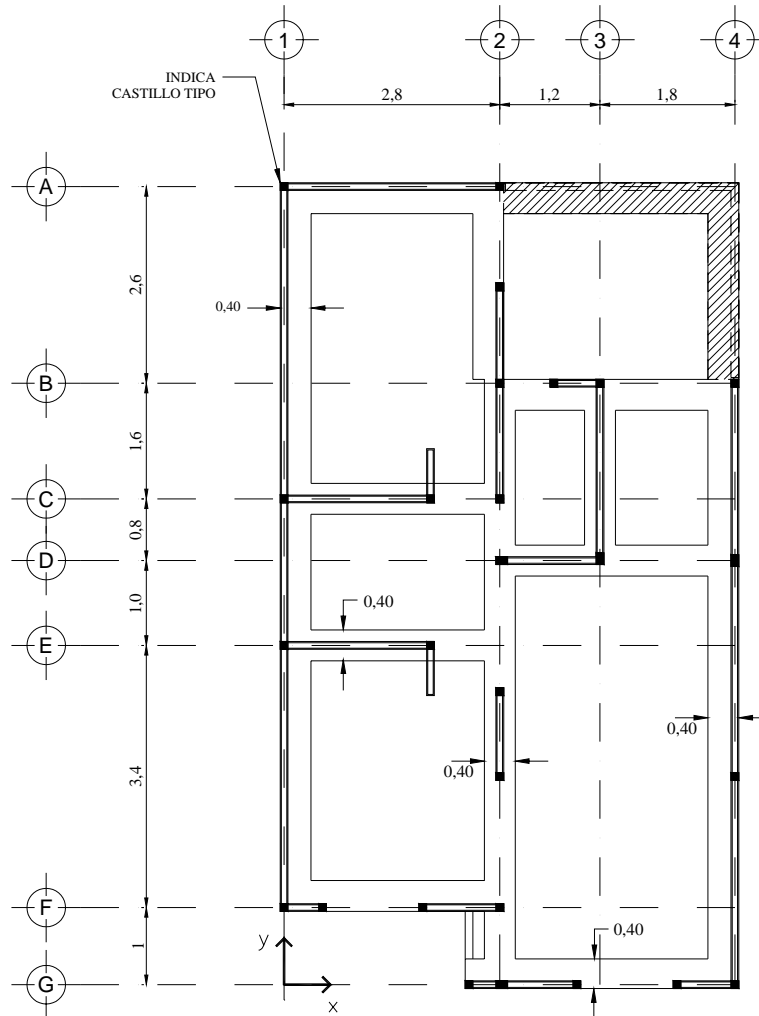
Planta de cimentación y de muros (acotaciones en m)
